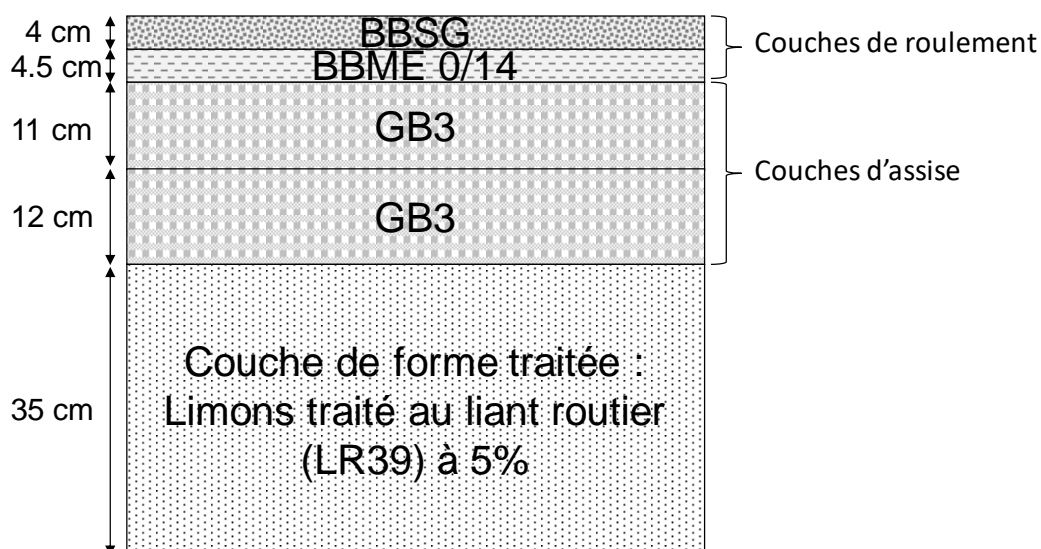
Structure de chaussée en place sur la section de prélèvement de la RD700
